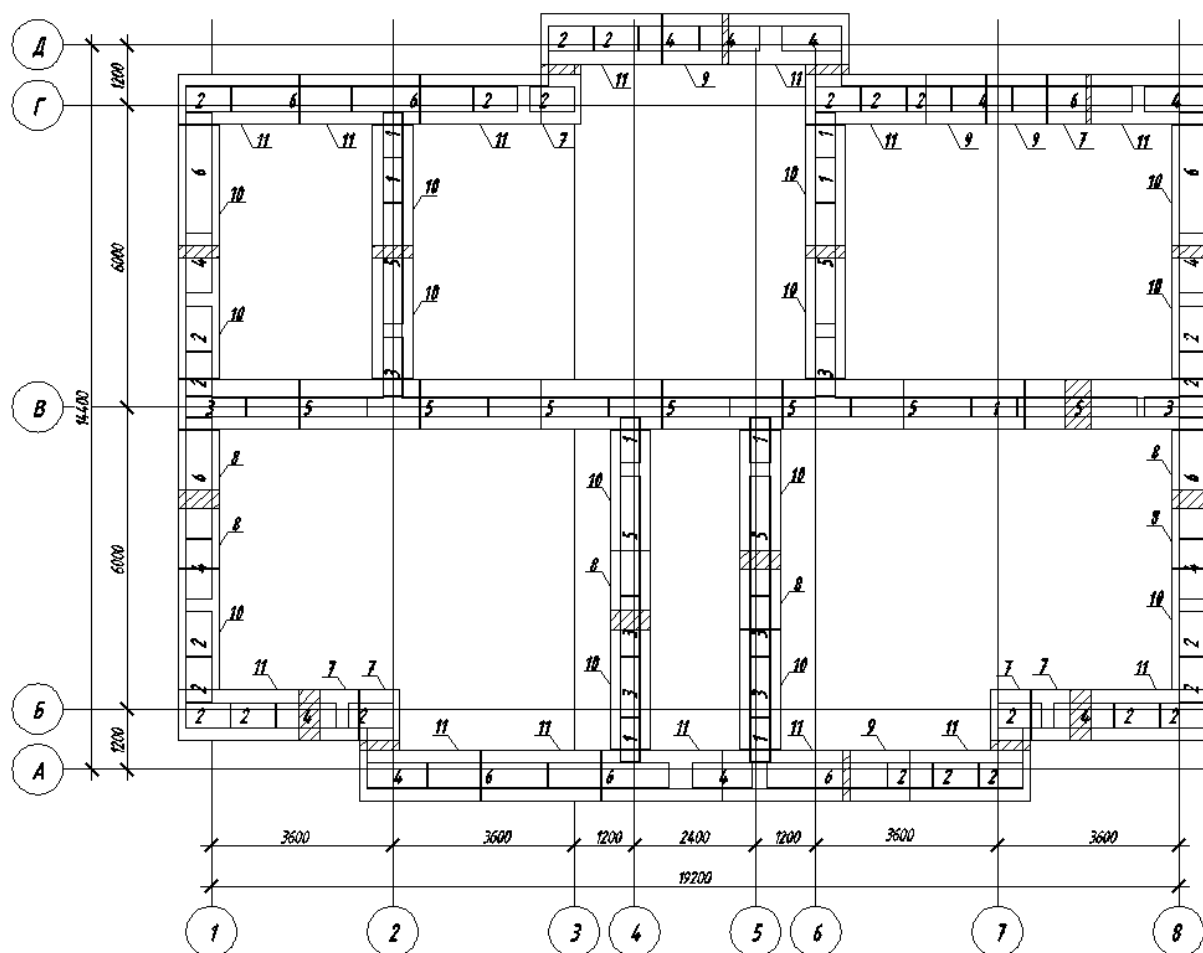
Раскладка фундаментных плит и блоков
